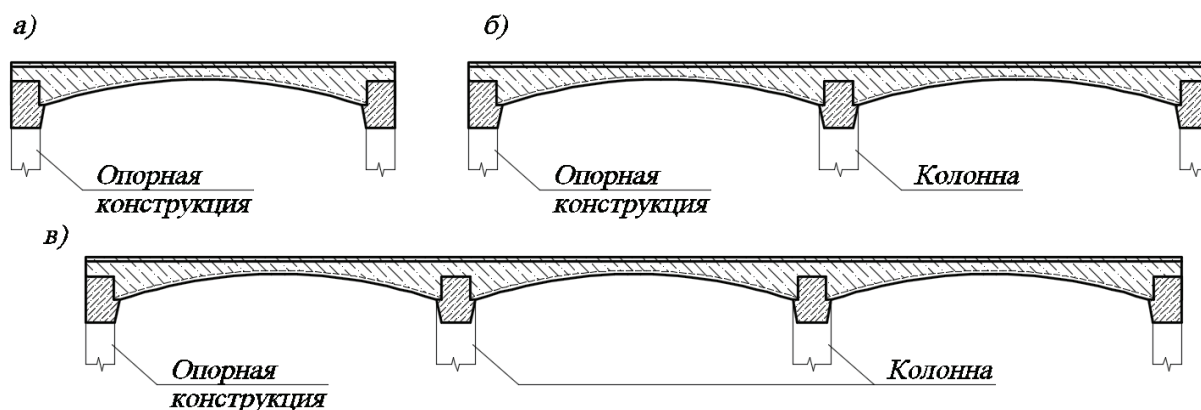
Варианты сборно-монолитного перекрытия подземного перехода с нижней сводчатой поверхностью:
